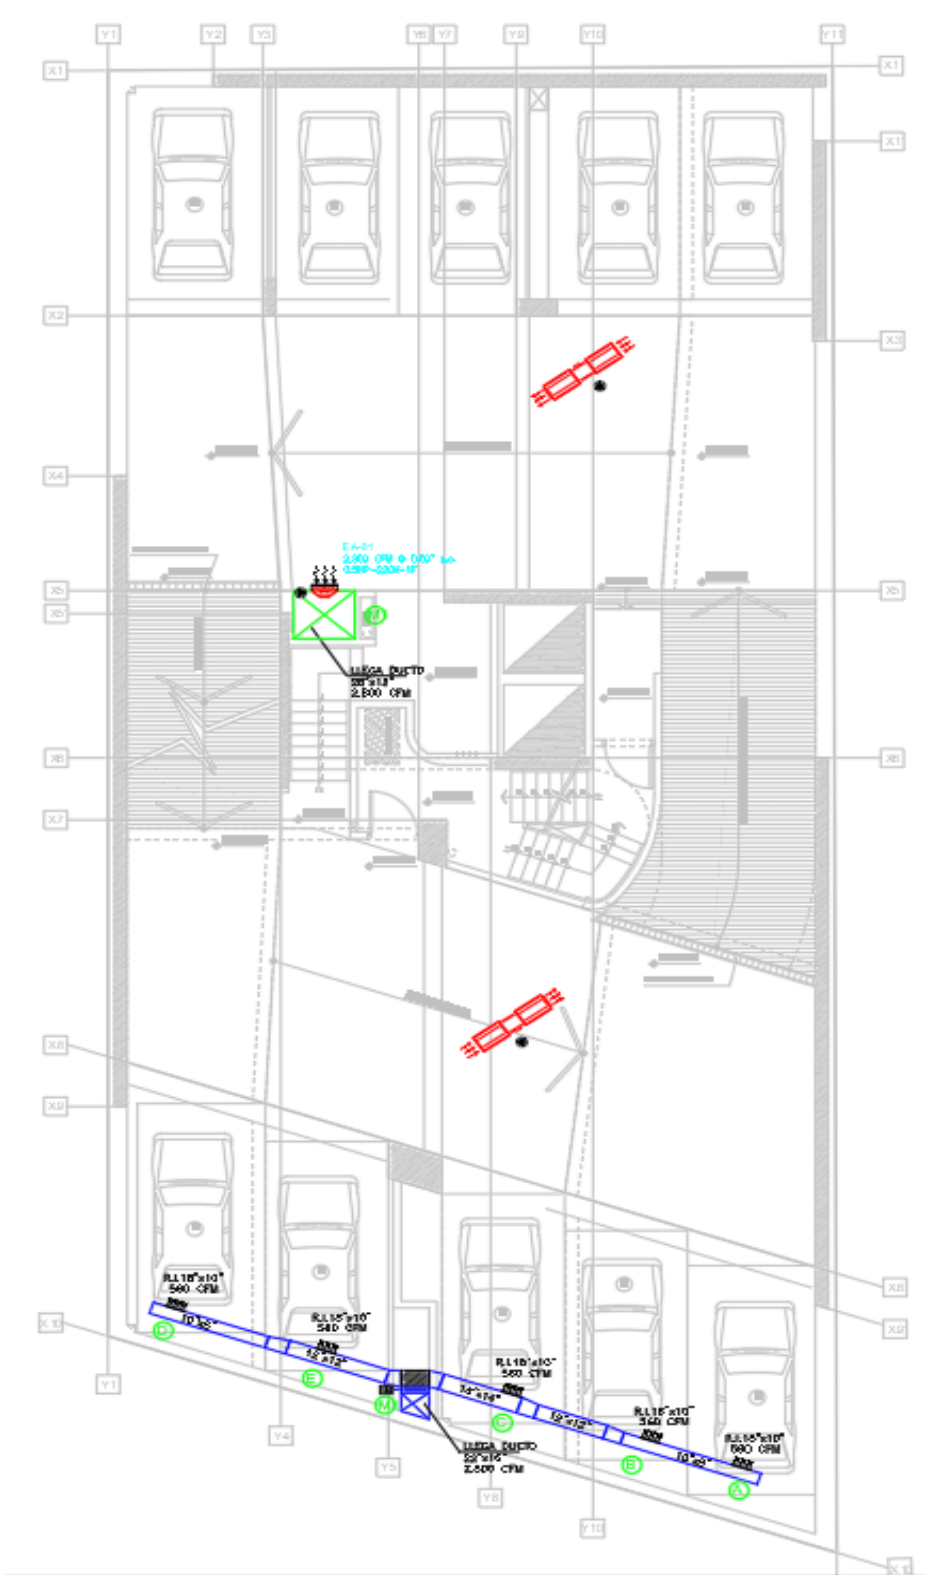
Planta típica de disposición de equipos jetfan. Elaborado en AutoCAD.
